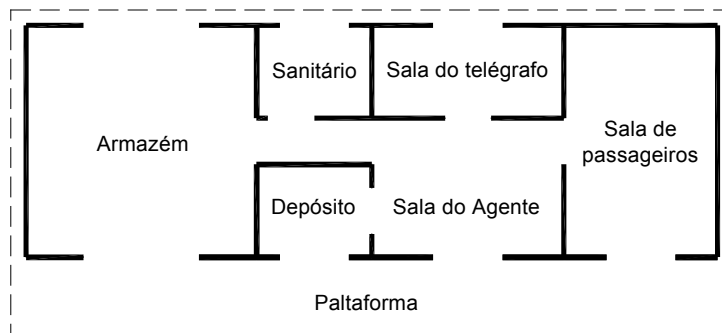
Planta esquemática da estação de Pulverização, Barra do Piraí. Sem escala. 2010.
